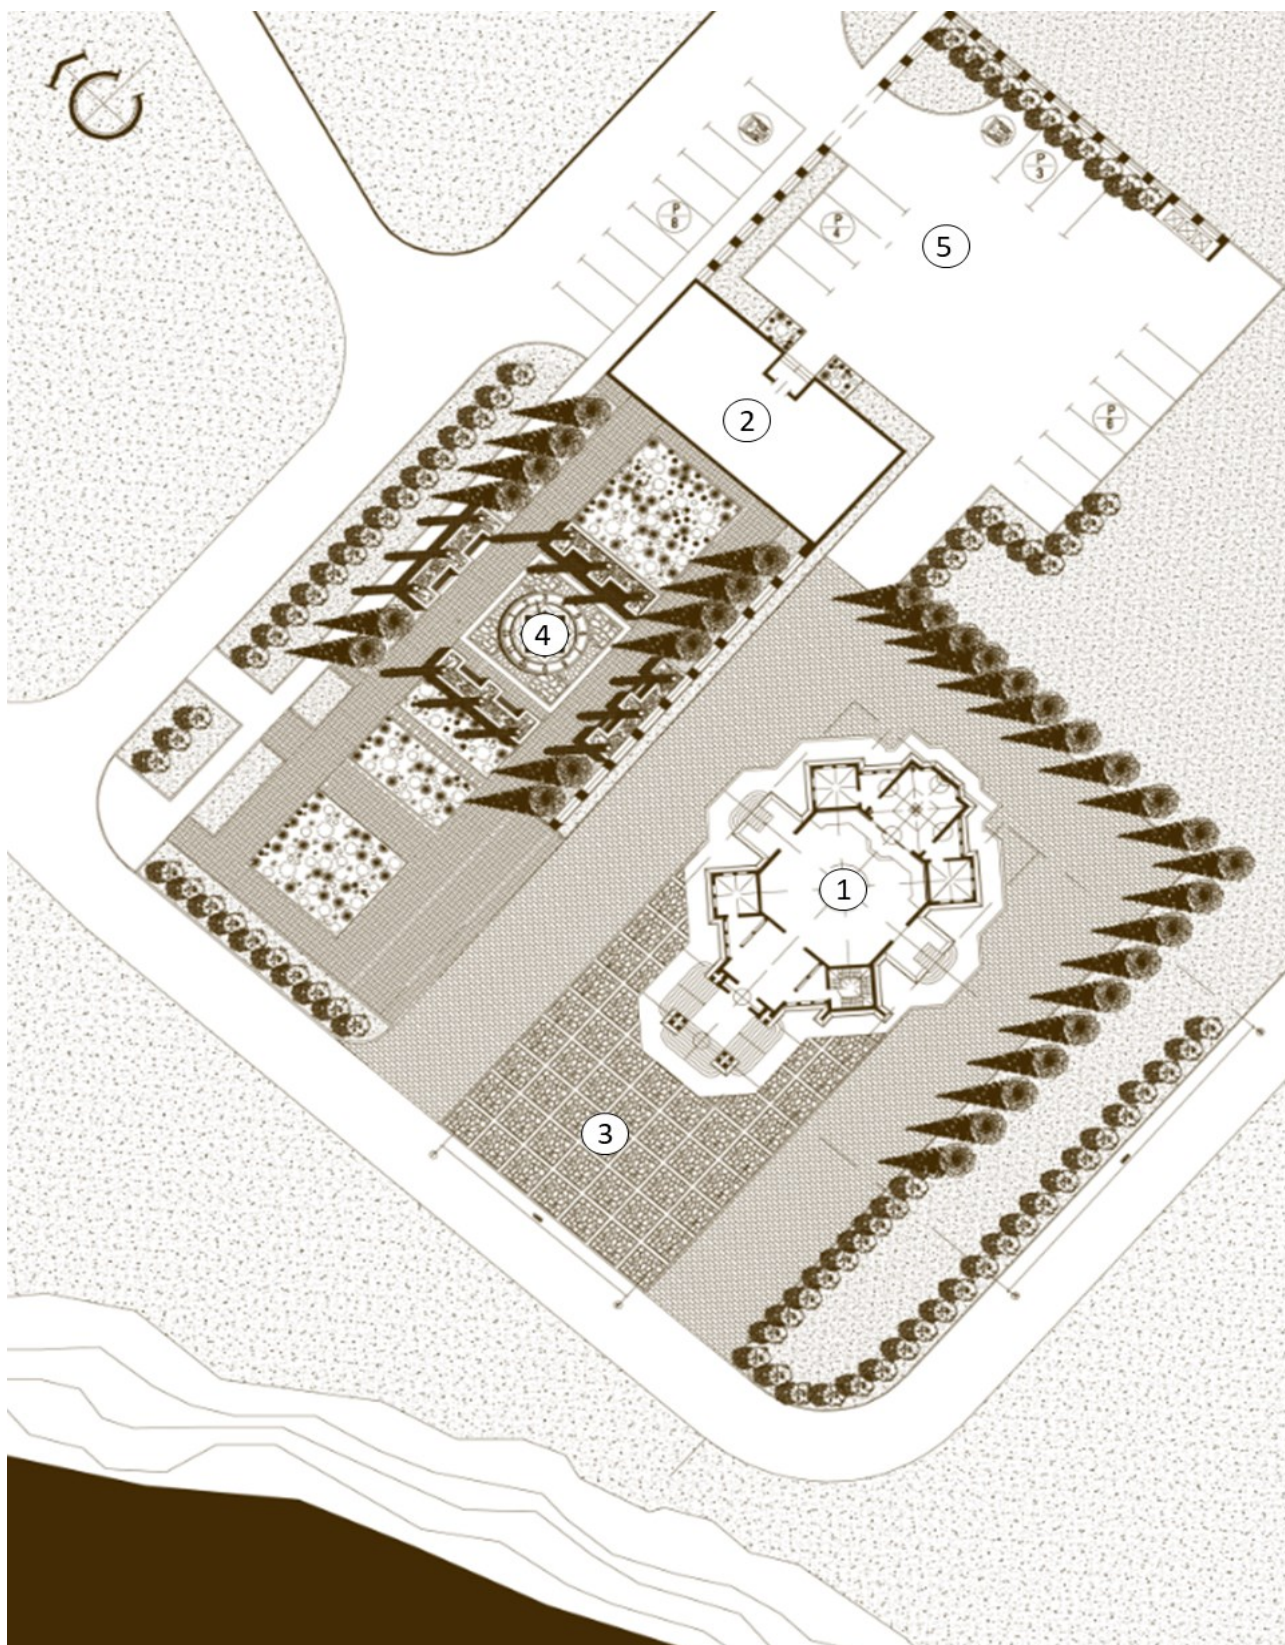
Схема генерального плана храма в г. Калининграде: 1 – здание храма; 2 – здание причтового дома; 3 – площадь; 4 – «Райский сад»; 5 – автопарковка
